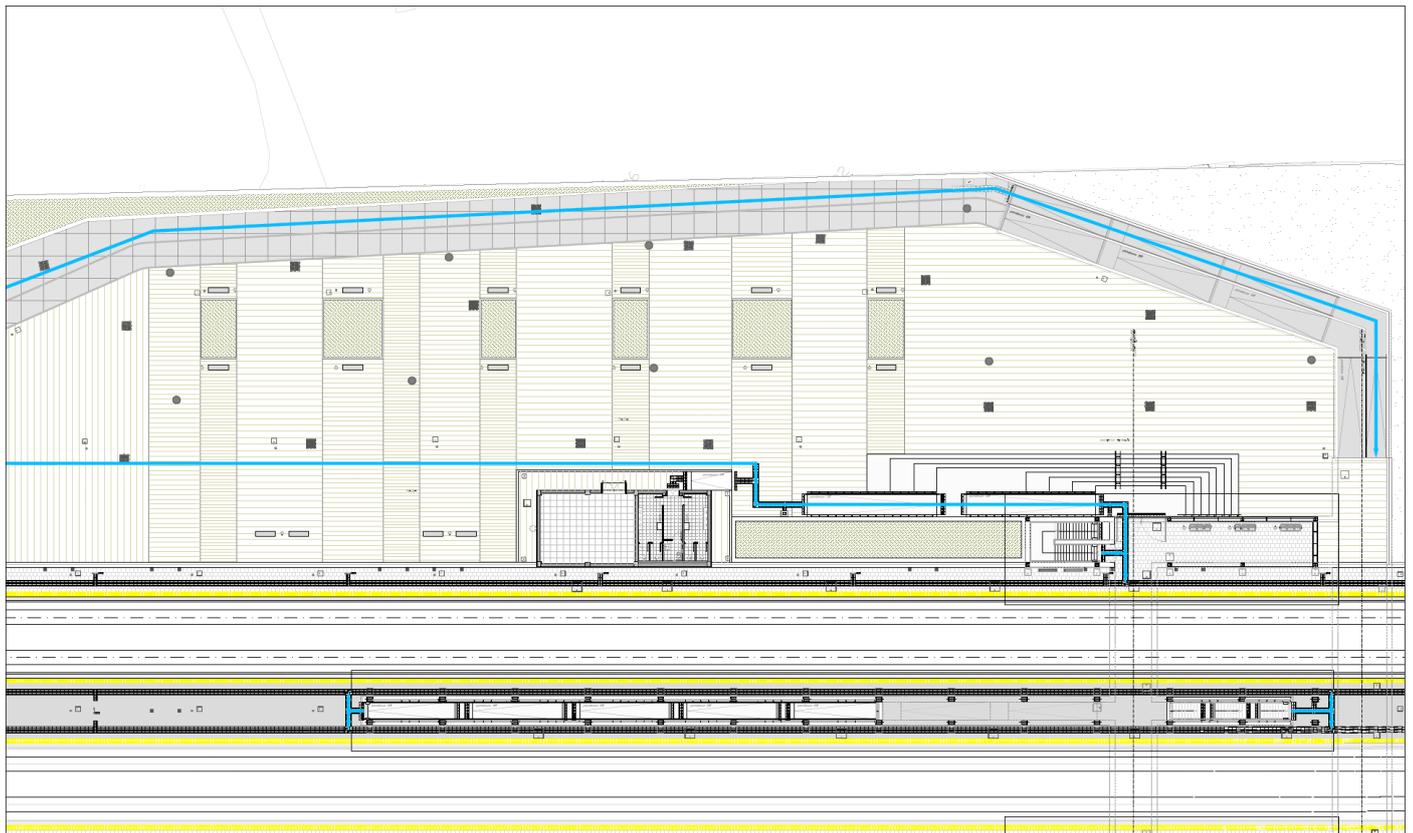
Pianta quota banchina con individuazione del PPO - Stralcio 2 di 2
